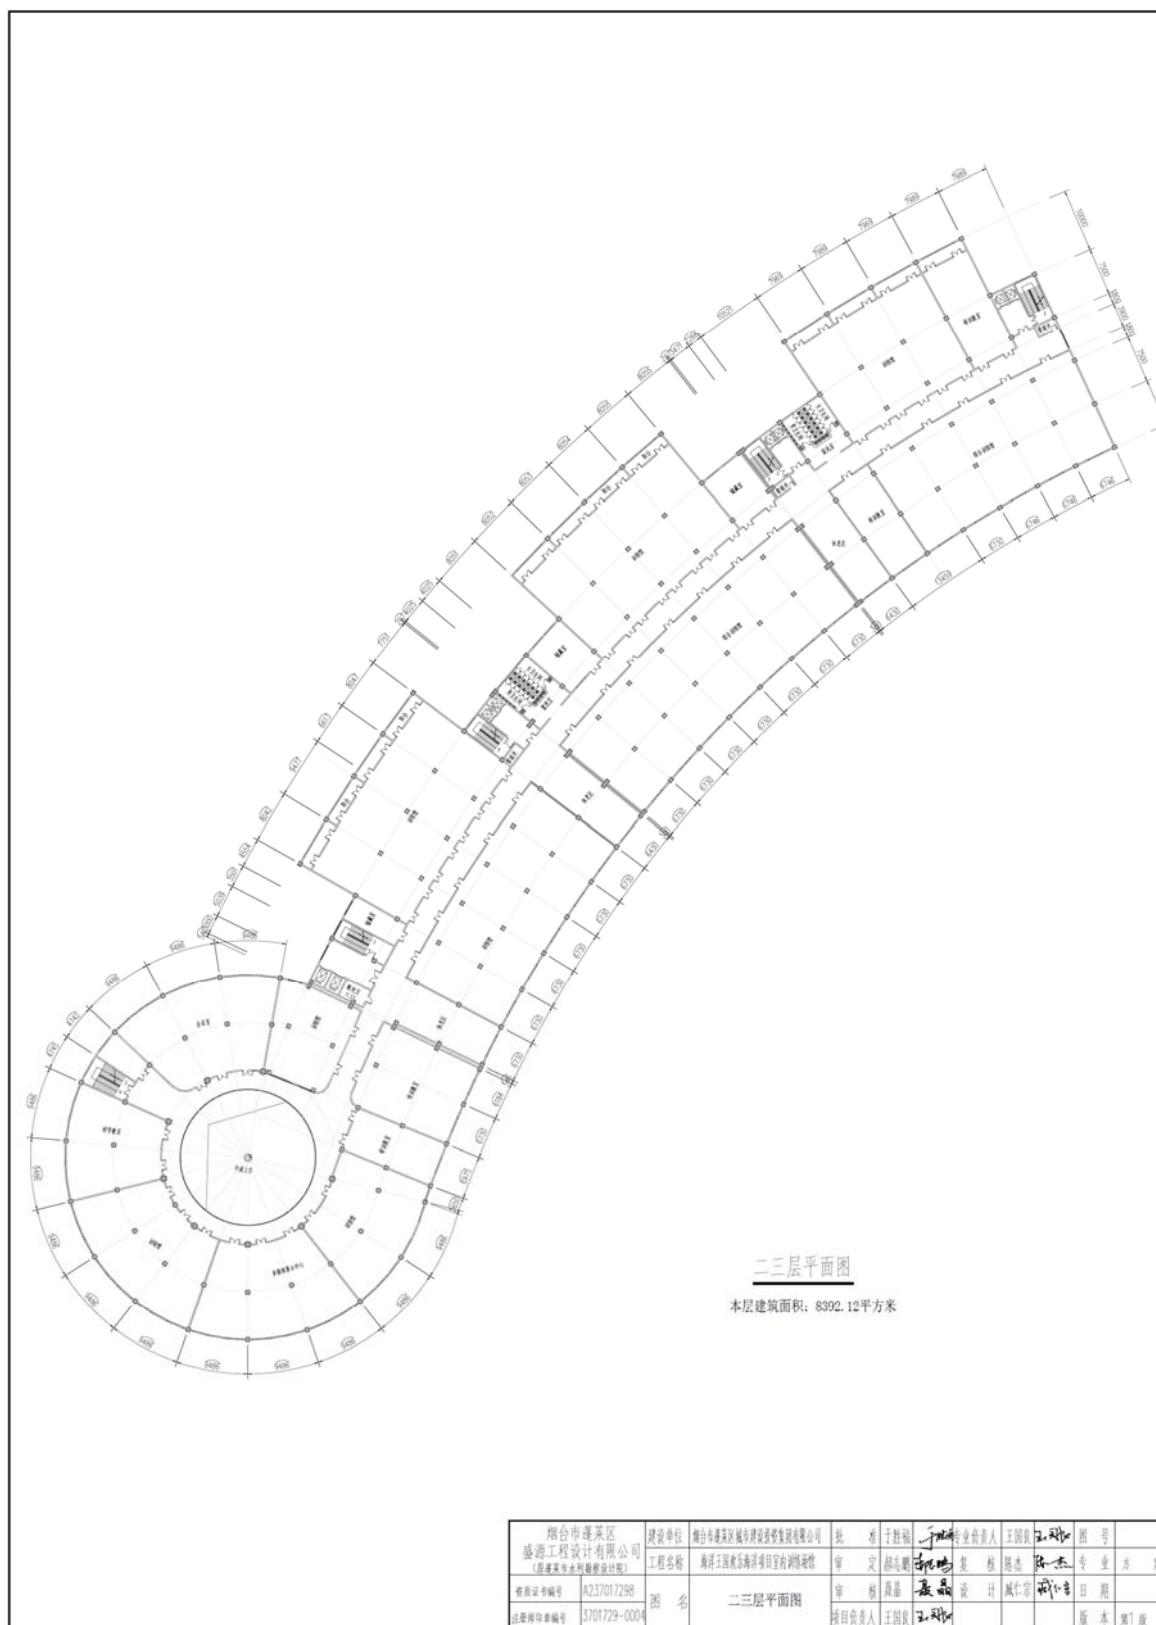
室内训练场馆平面布置图（二、三层）
